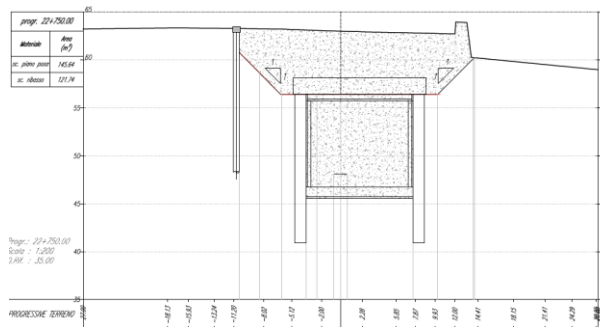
Stralcio della pianta scavi e delle sezioni dell'area dei fabbricati Italcostruzioni (Rif. [VIII])
